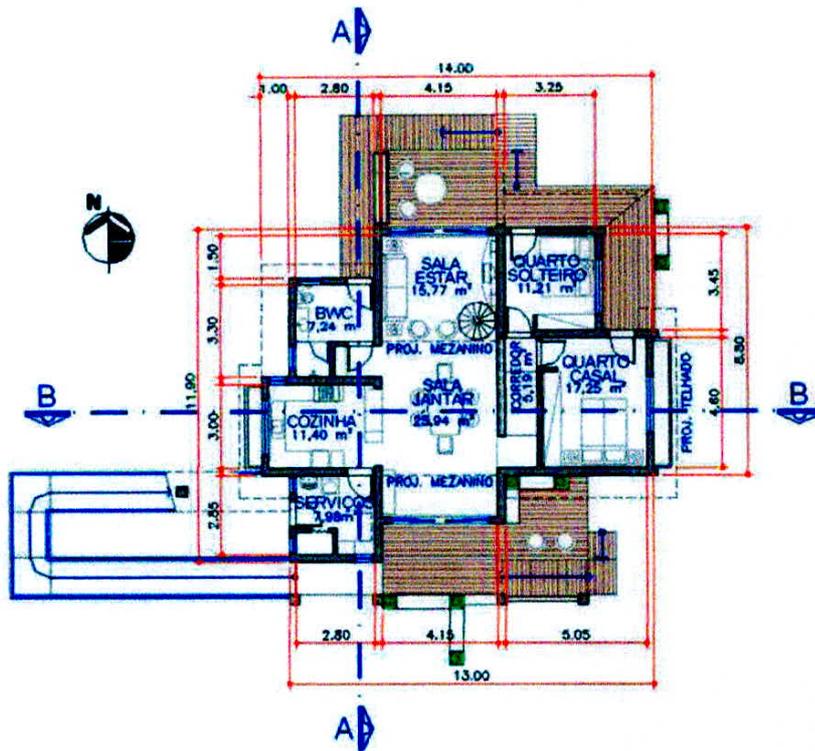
Planta baixa da Casa Eficiente – Pavimento Térreo
